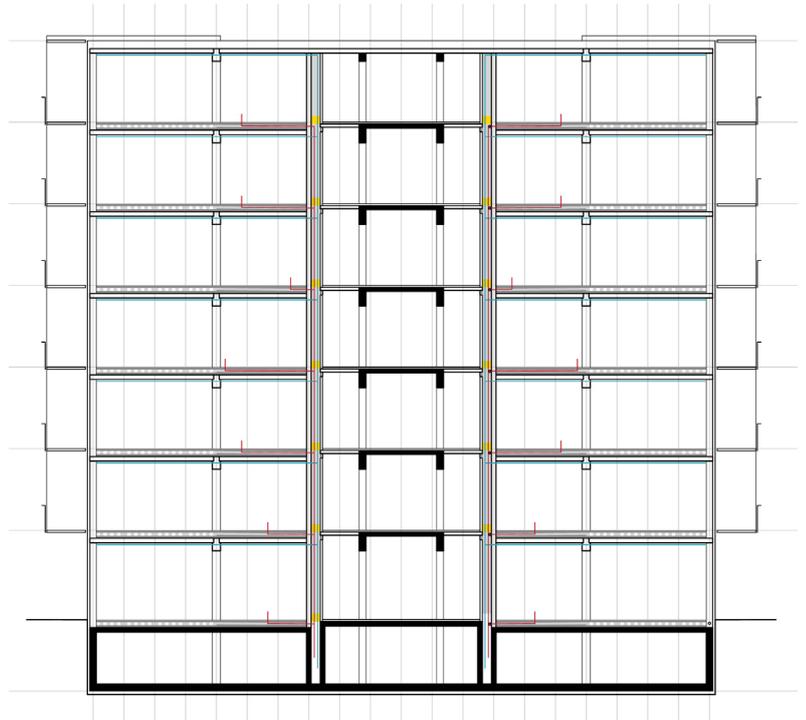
Lage der Sprinklerleitungen im Schnitt (blaue Linien)
